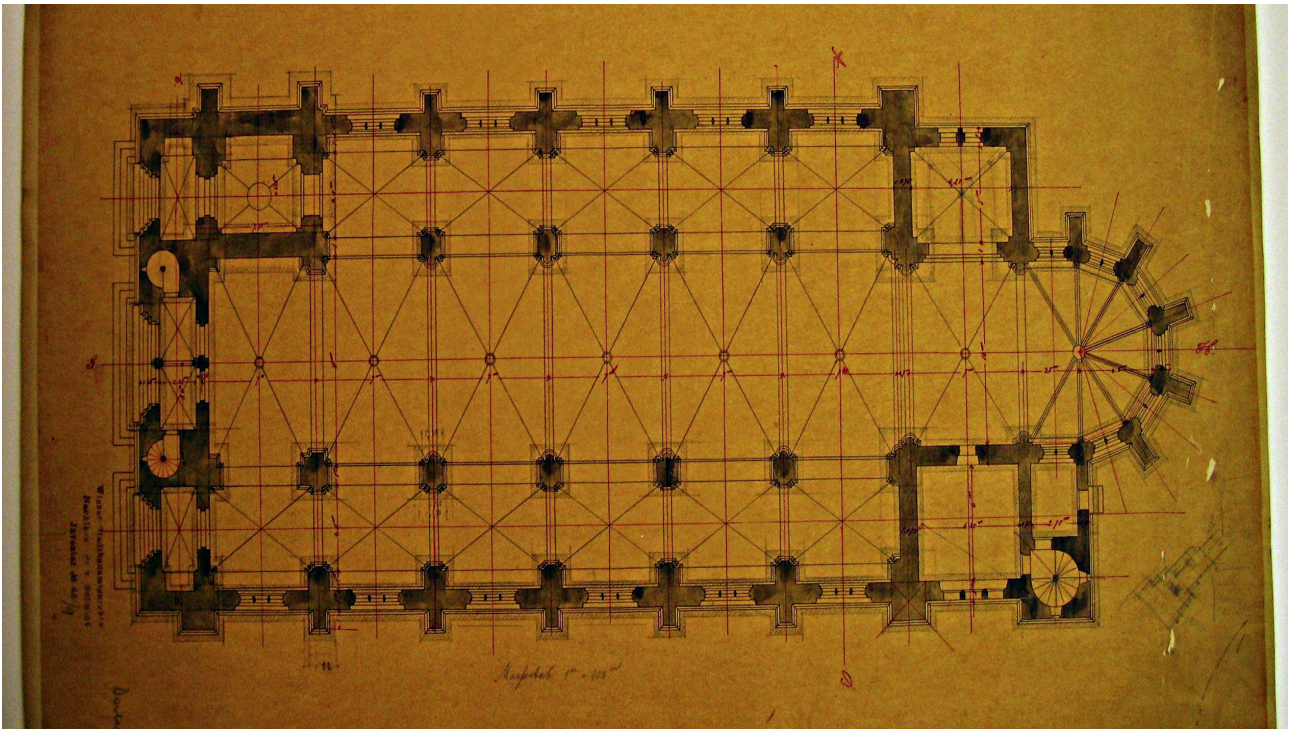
WM, Inv.-Nr. 157.45/9 zweiter Entwurf, Grundriss
